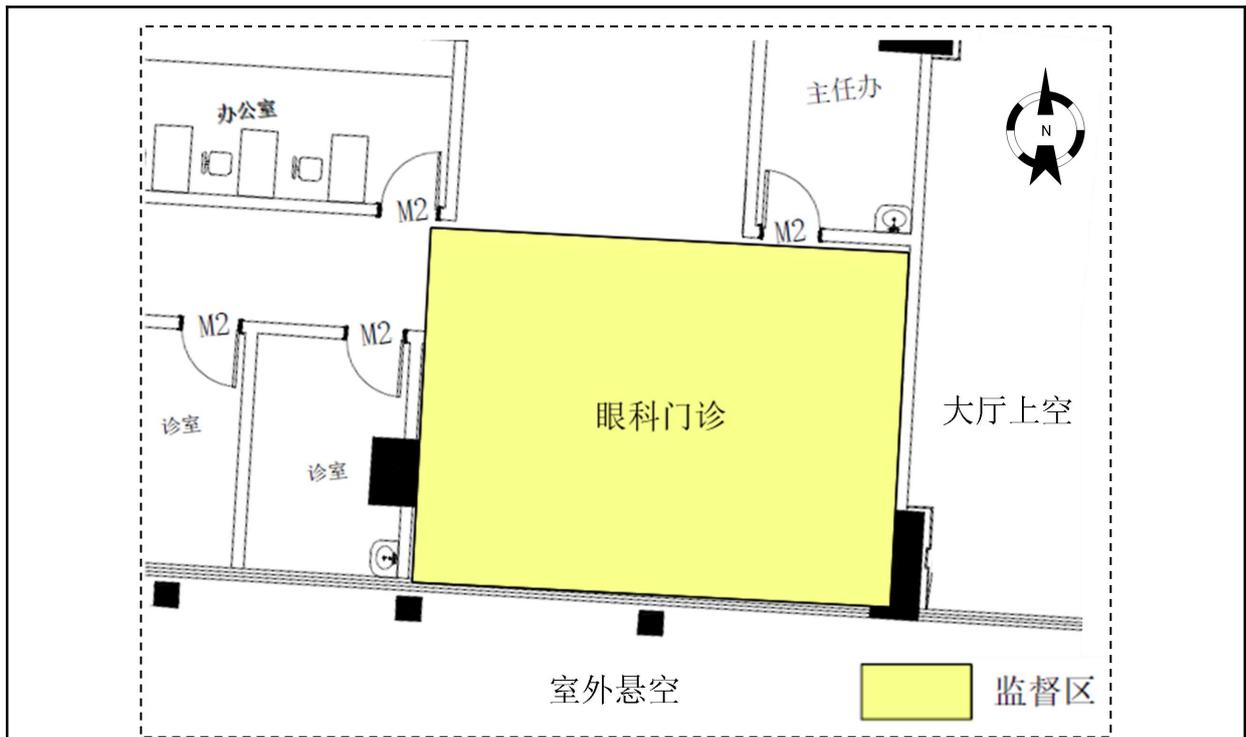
1 号楼四楼（DSA 机房下方楼层）平面布置及分区示意图
